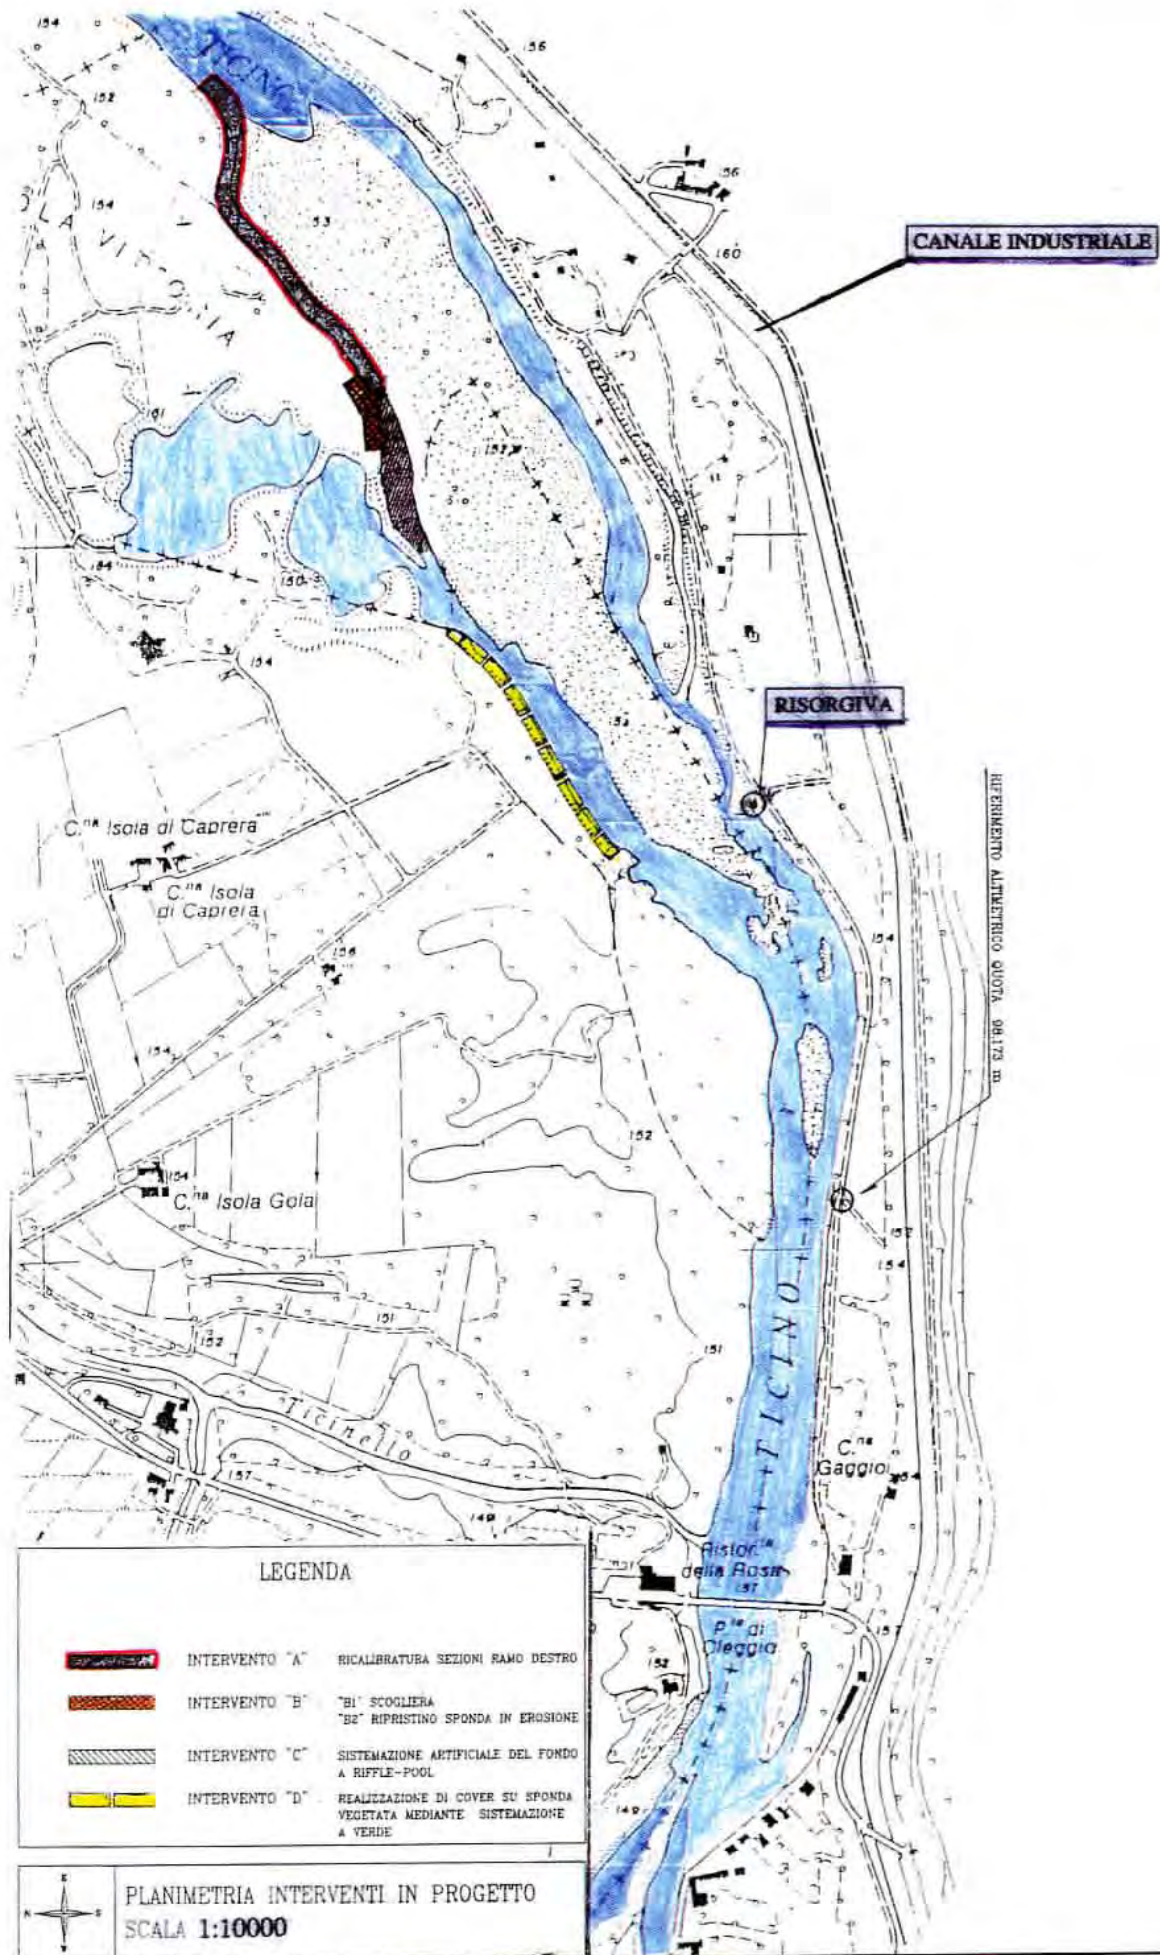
/1 : SCHEMA PLANIMETRICO DEGLI INTERVENTI NEL TRATTO SPERIMENTALE A MONTE DEL PONTE DI OLEGGIO
